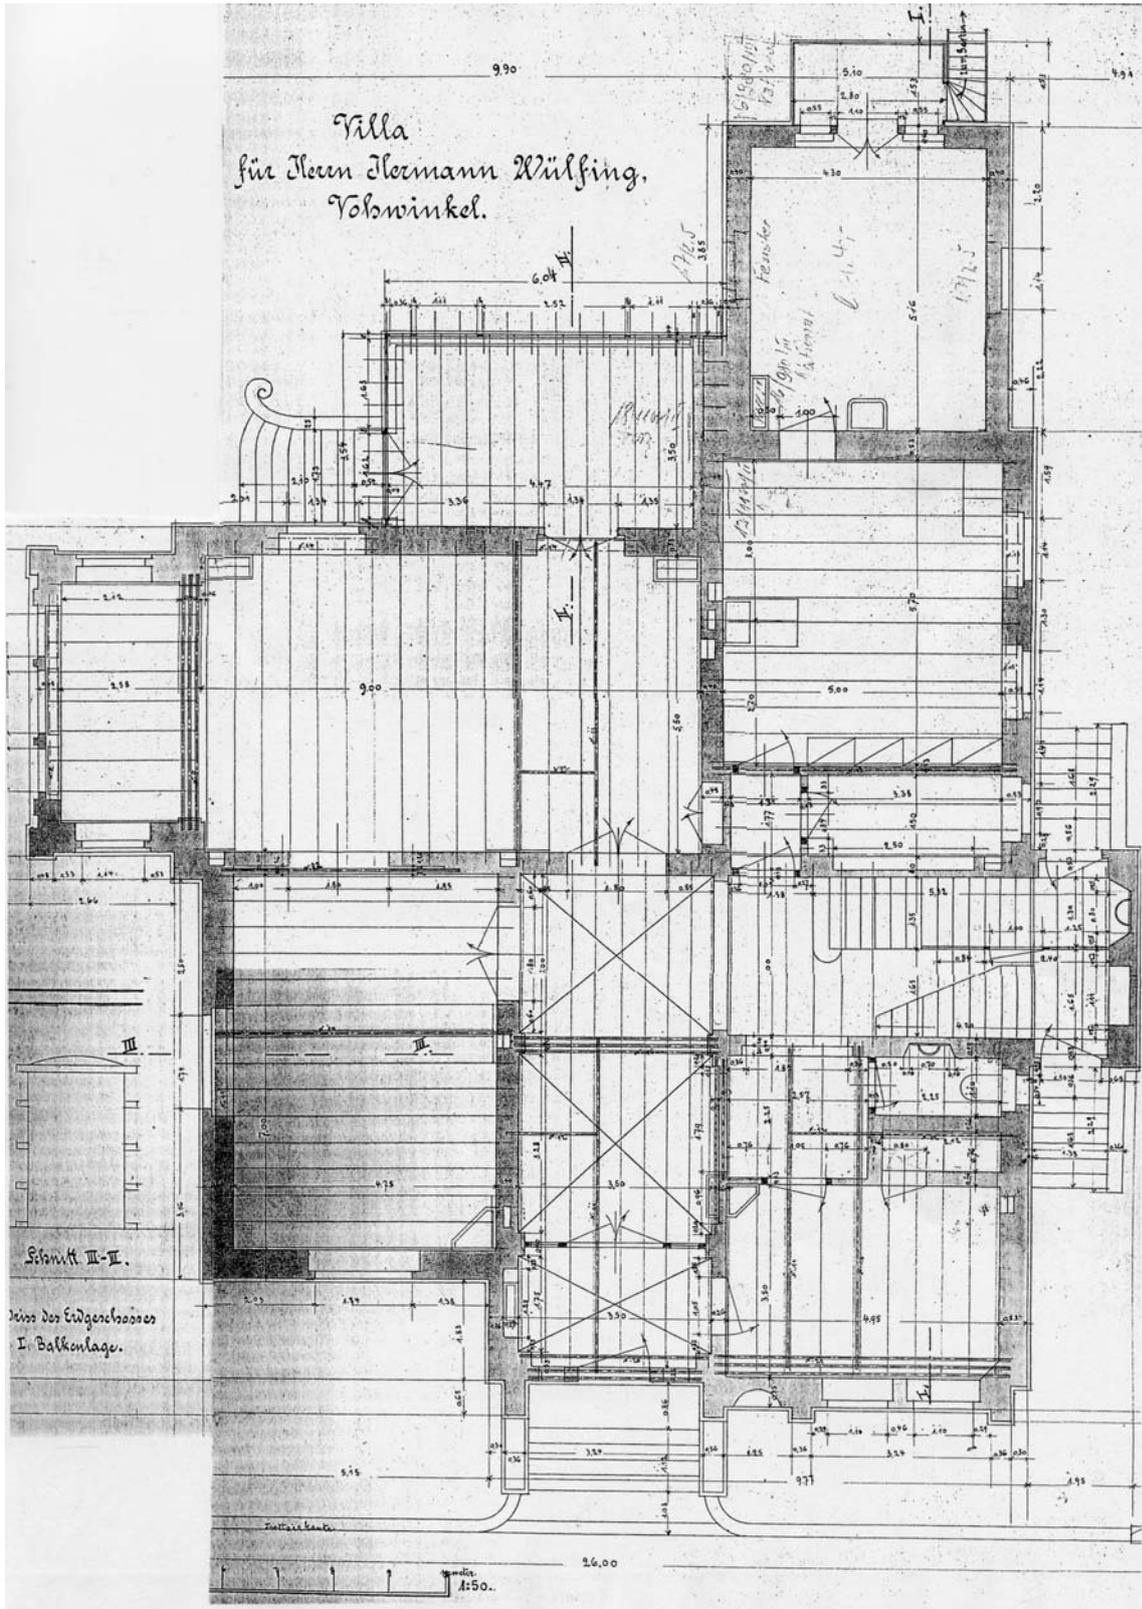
Villa Wulfing, Grundriss Erdgeschoss, angefertigt vom Bauunternehmer Wilhelm Dickel, 1905
